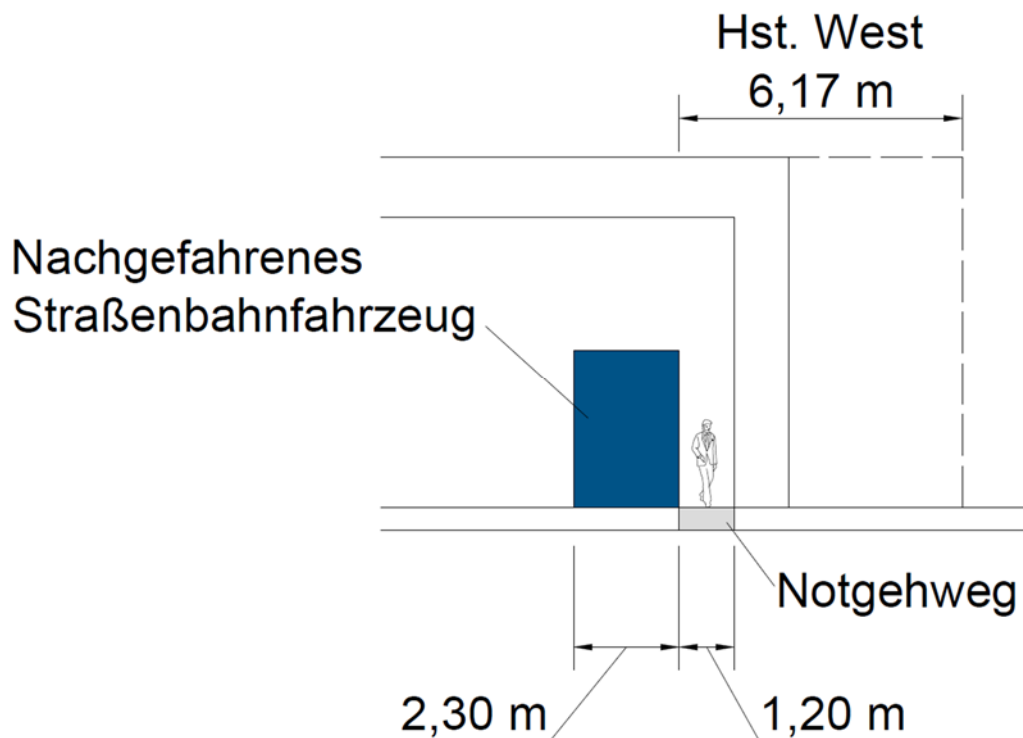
Haltestelle West mit nachgefahrenem Straßenbahnfahrzeug (Querschnitt, Prinzip)
